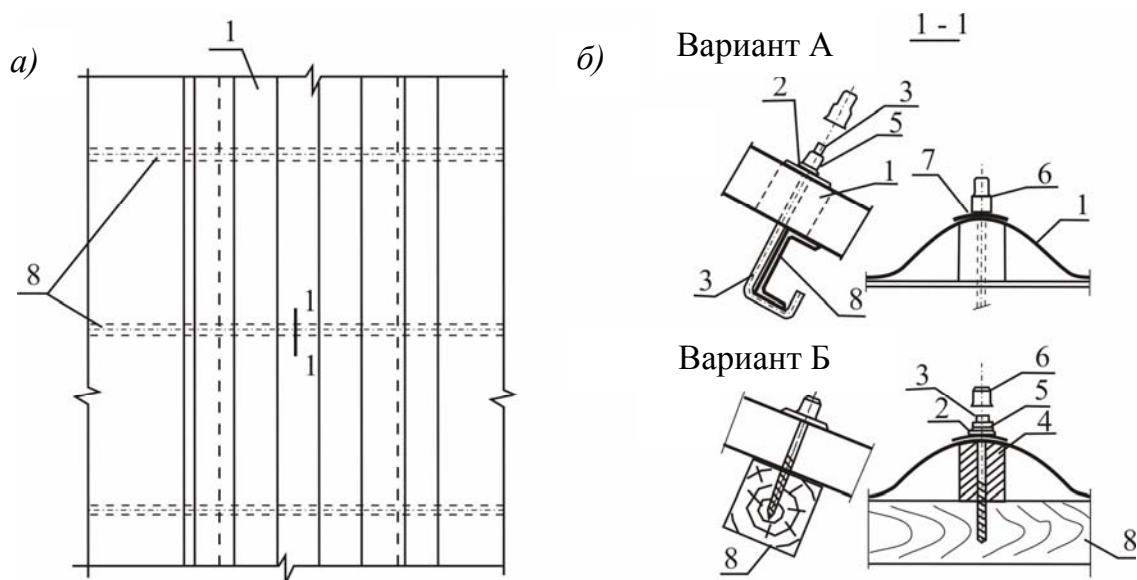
Узлы крепления из светопропускающего волнистого ПВХ к балкам покрытия: а – фрагмент покрытия, б – узлы крепления (к стальным – вариант А, деревянным – вариант Б); 1 – светопропускающий элемент из ПВХ; 2 – накладка; 3 – крепежный элемент; 4 – хомут; 5 – шайба; 6 – защитный колпачок; 7 – герметизирующая прокладка; 8 – балка
